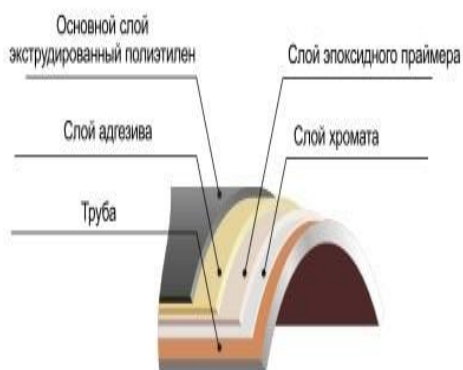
Весьма усиленная (ВУС) гидроизоляция трубопроводов
